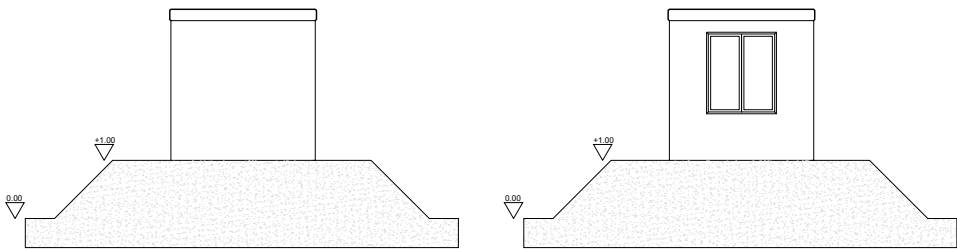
Viste planimetriche e in prospettiva del locale controllo e monitoraggio
